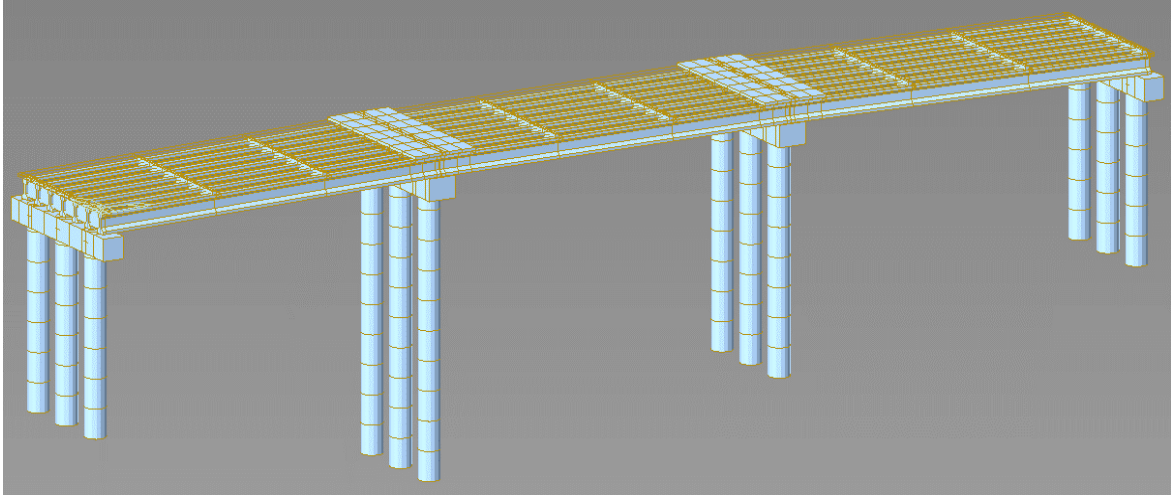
Vista extruida del modelo (losa sobre pilas)
